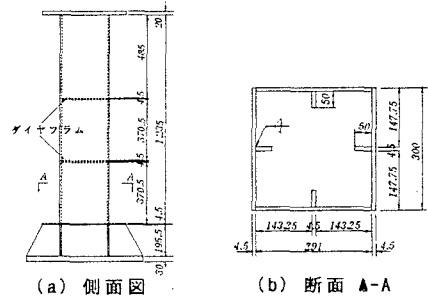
実験供試体の寸法諸元 (寸法単位: mm)
